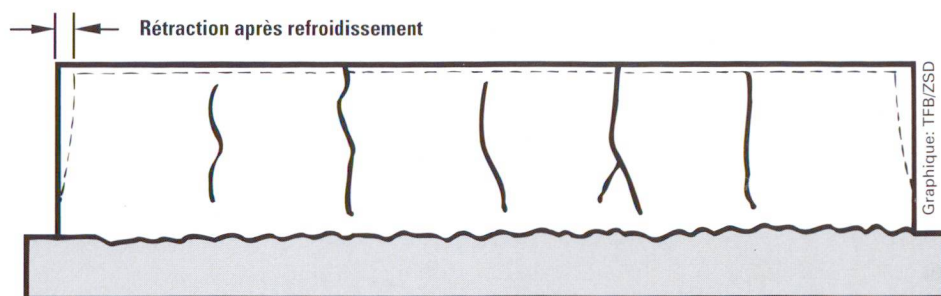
Fissures largement ouvertes dues à la déformation entravée lors du refroidissement du mur bétonné sur une fondation (selon [10], modifié).
